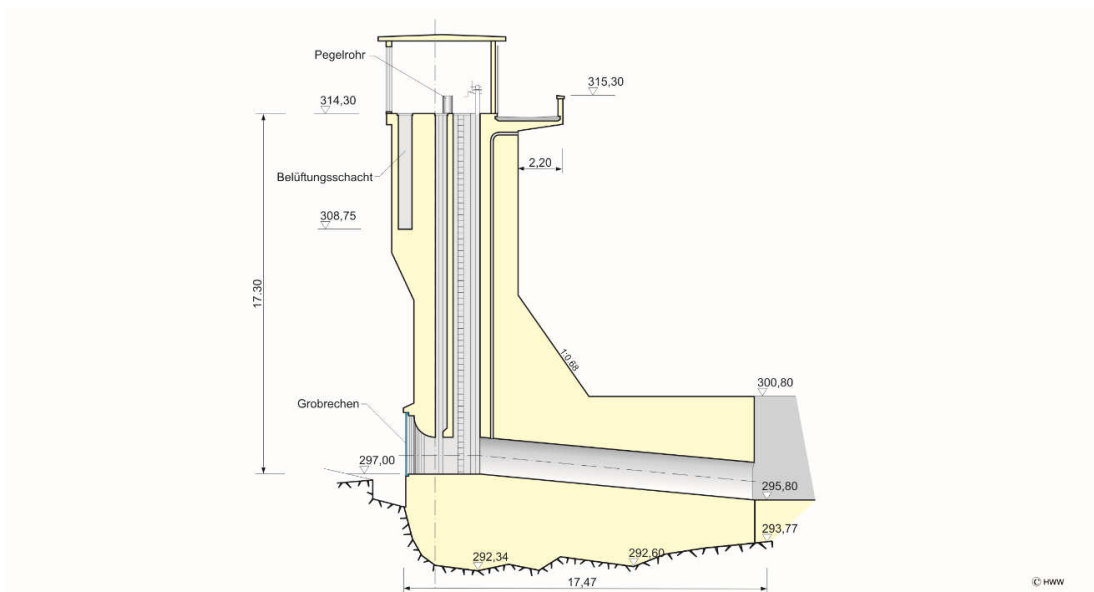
Okertalsperre Unterwasserbecken Querschnitt Grundablass
